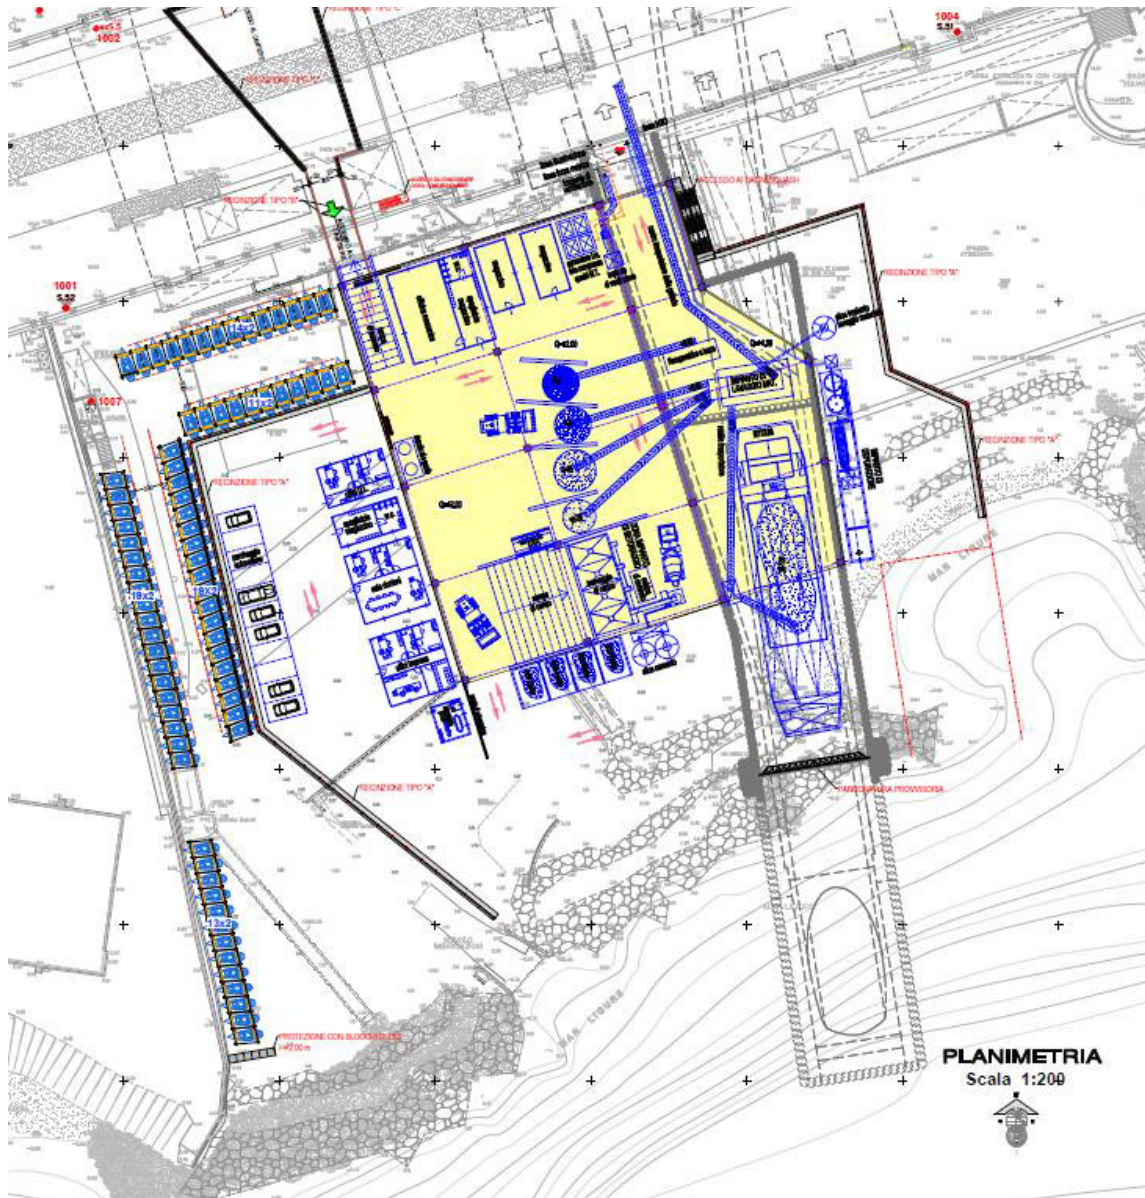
Planimetria area di cantiere zona C.so Italia
